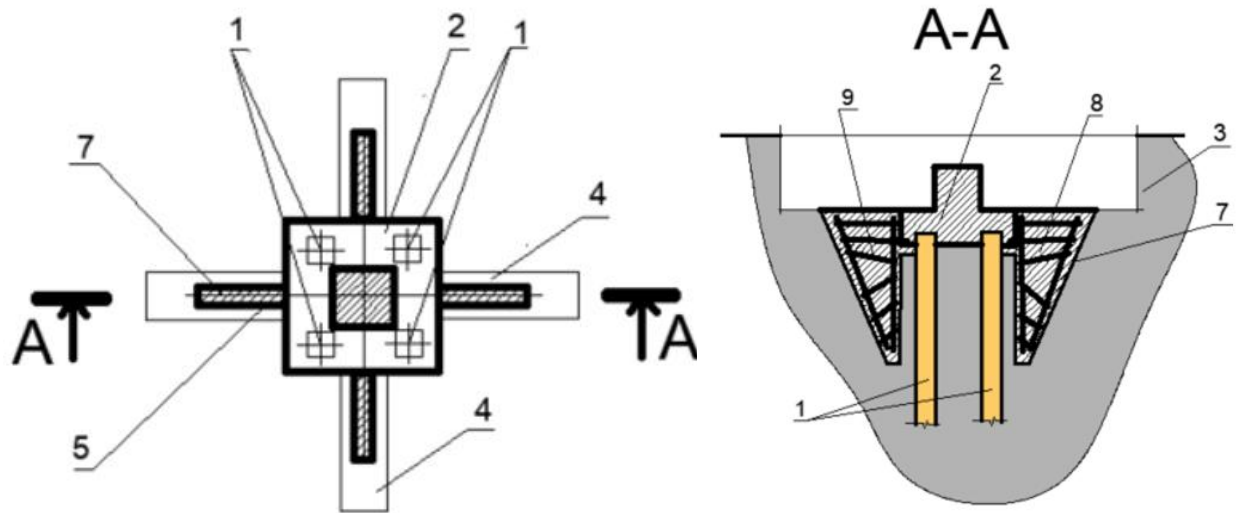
Схема елементів підсилення пальового фундаменту
